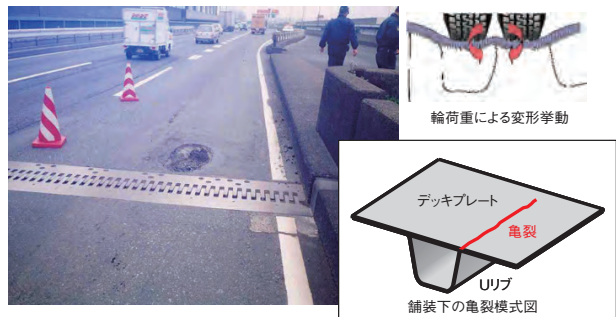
鋼床版デッキプレートの疲労損傷
